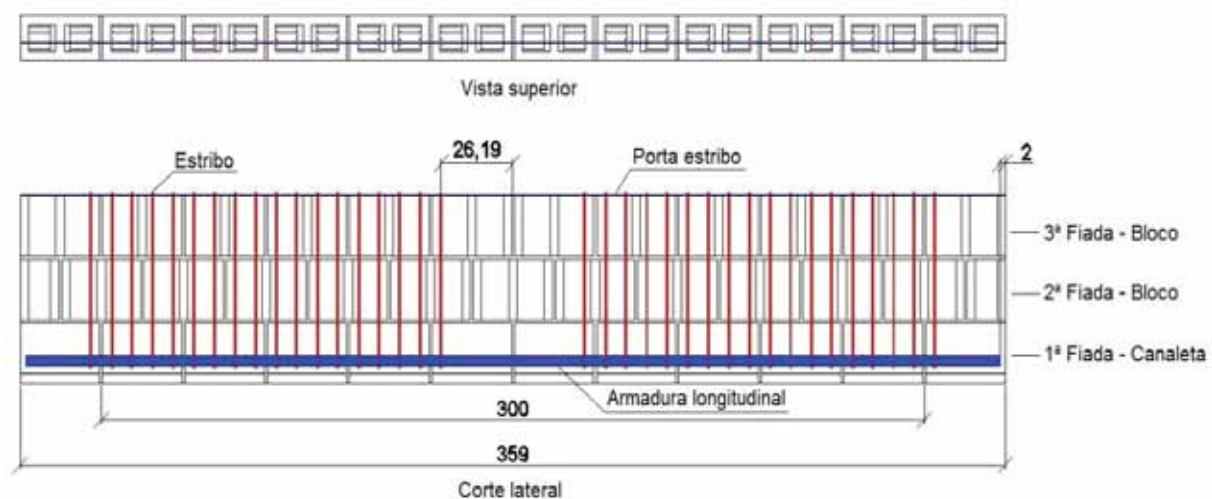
Detalhamento das vigas de alvenaria estrutural armada – Cotas em centímetros
